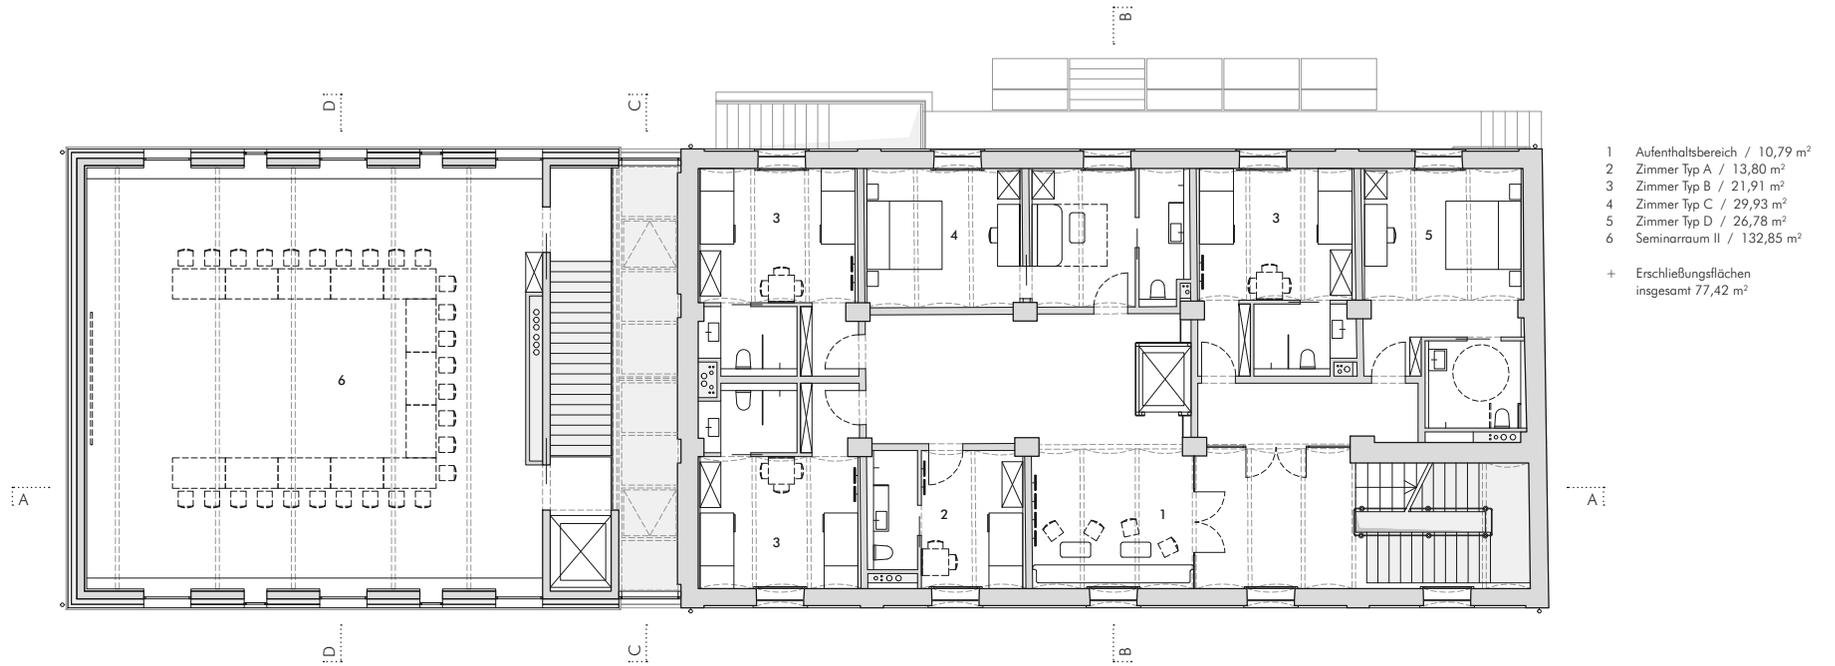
Grundriss 1. Obergeschoß, Entwurf, M 1:200
